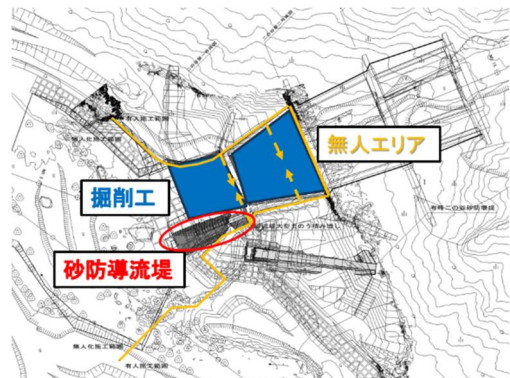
「R6 有峰地区溪岸（二の谷）工事」平面図
